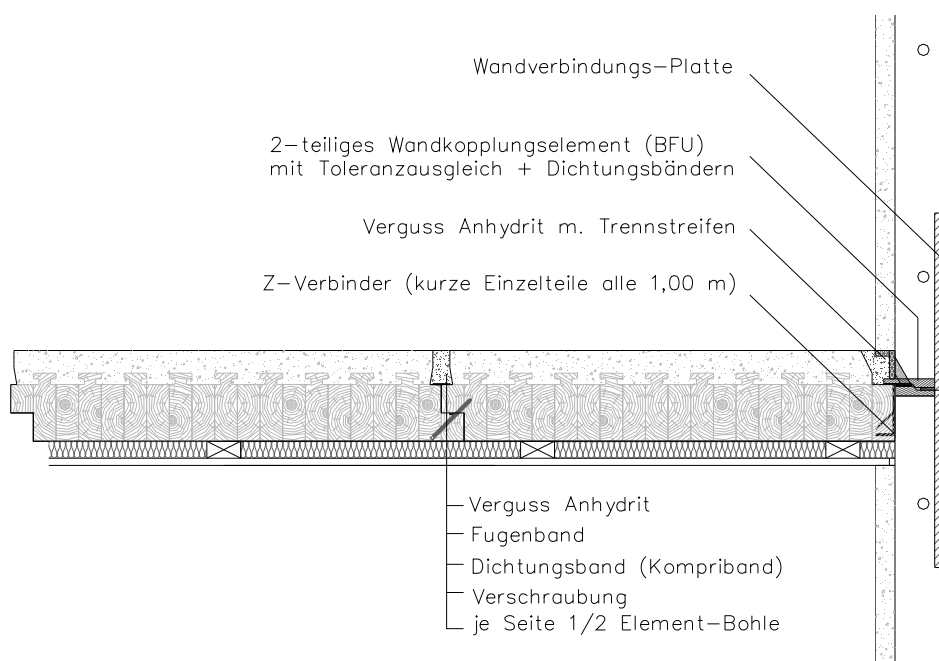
Deckenelement Längsstoß und Anschluss an Streichwand
